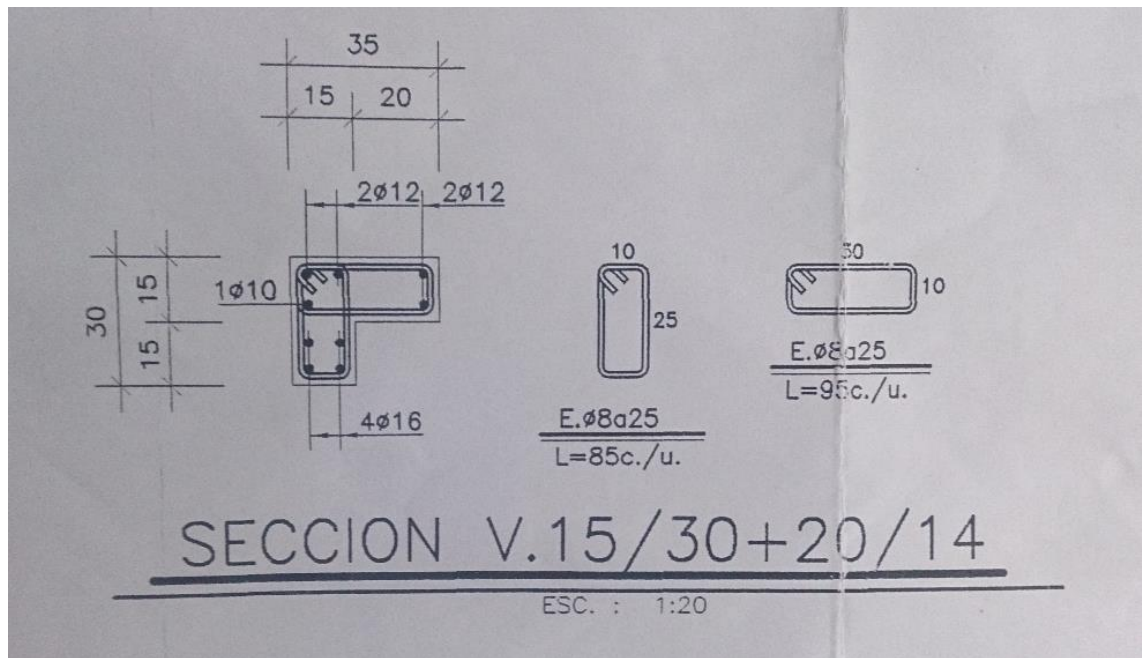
Detalle de las vigas invertidas de hormigón armado diseñados en el edificio.
